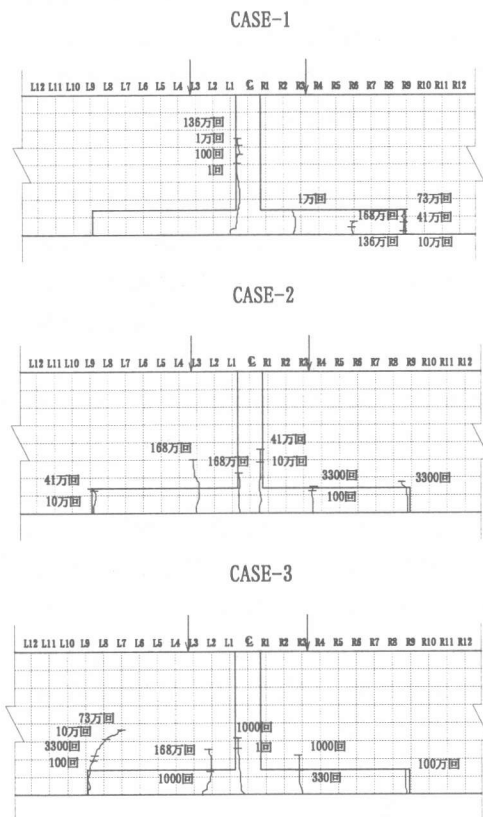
ひび割れ発生状況図(疲労試験時)
